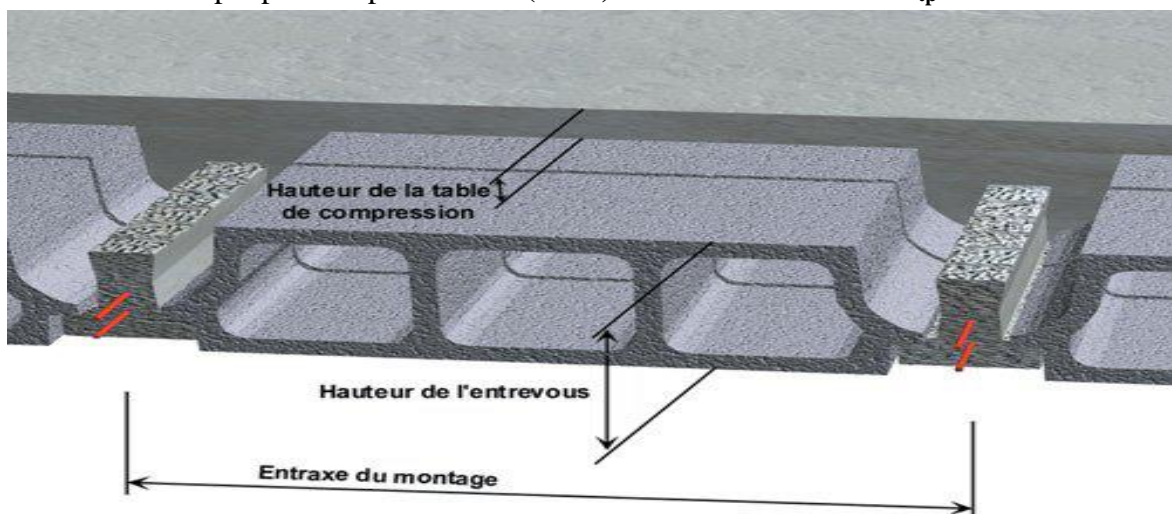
Coupe d'un plancher à corps creux (Semi préfabriqué).
